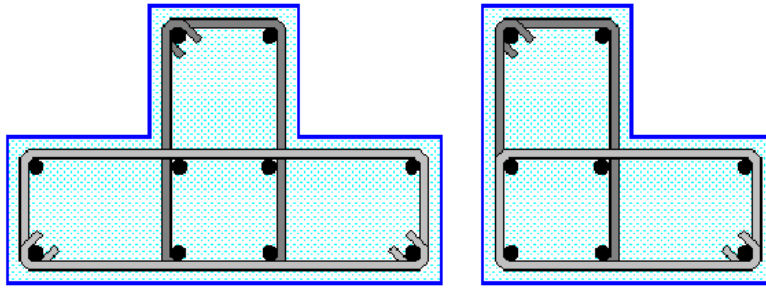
Varillas longitudinales y estribos recomendados en diferentes secciones de columnas.
